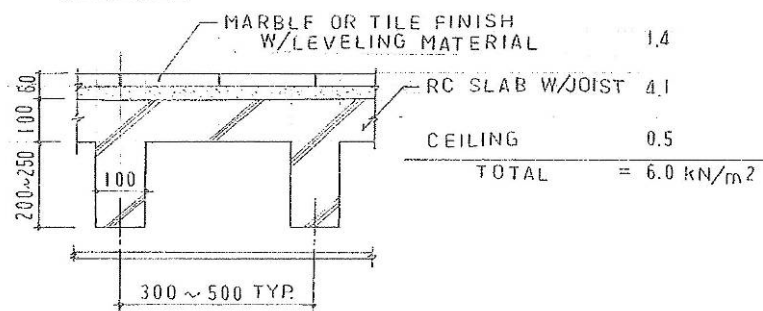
Poids unitaire de la toiture typique et du système de plancher
